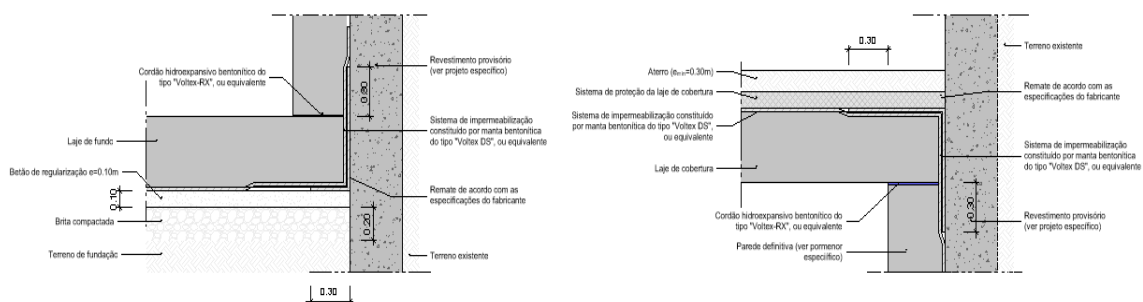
Sistema de impermeabilização do revestimento definitivo das estruturas executadas a céu aberto
